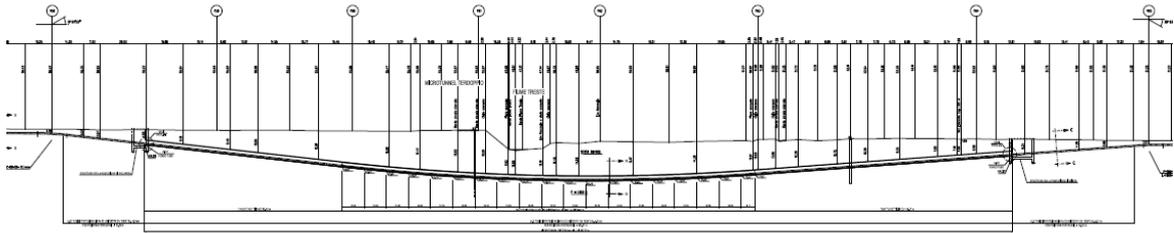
Attraversamento fiume Treste - Sezione schematica di progetto
